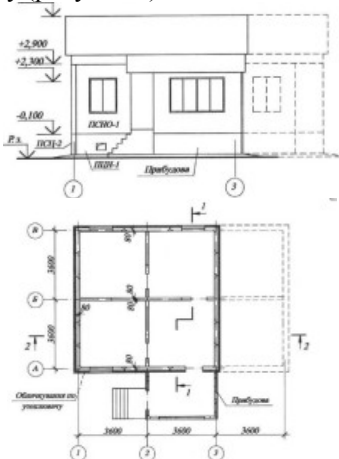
Основні технічні рішення системи «Тепла панель»: а - фасад 1-3, б - план на поз. 0,000 / Basic technical solutions «Warm panel»: а – facade 1-2, в - plan at elevation 0,000
